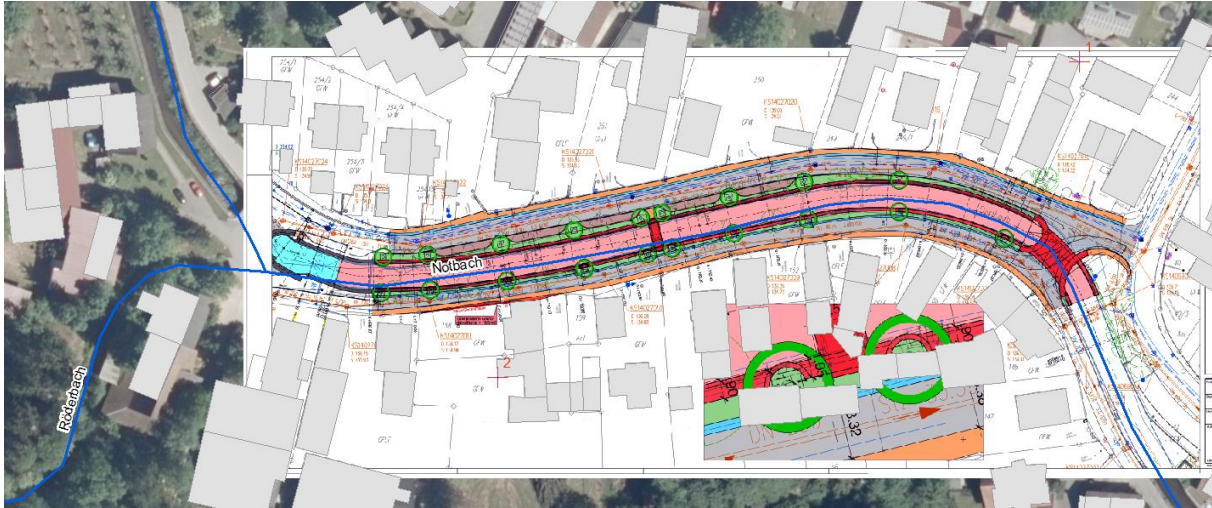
HWSK Ottersweier mit Lageplan Gewässerausbau Dorfbach/Notbach (Zink Ingenieure 2019)
